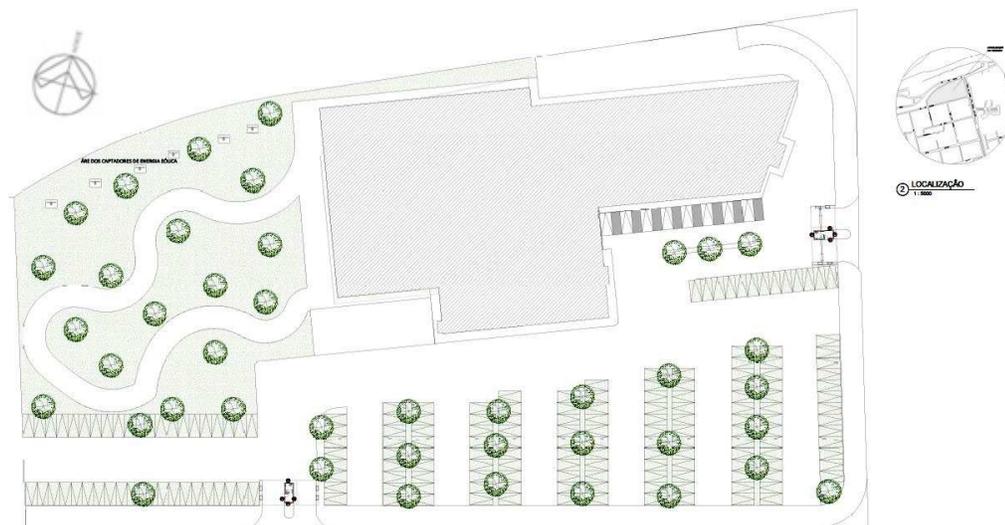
Planta de Implantação e Localização do Projeto. Fonte: O Autor
